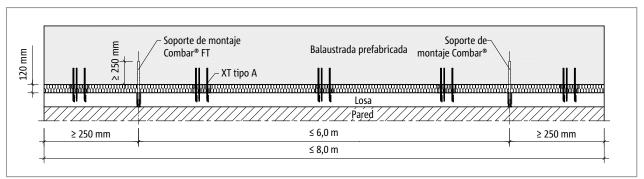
Schöck Isokorb® XT tipo A con soporte de montaje Combar® FT: Distancias al borde y longitud mínima de integración en la balaustrada prefabrica-
